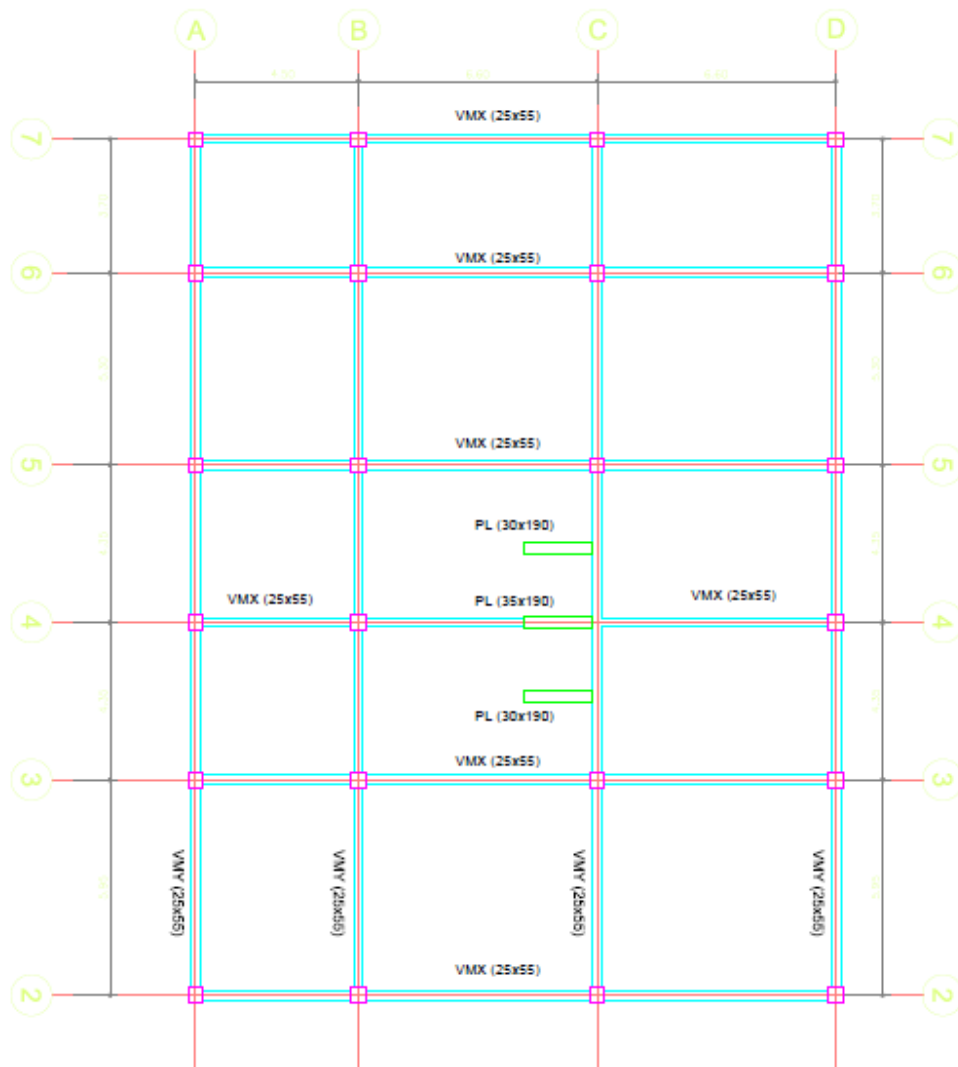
Planta arquitectónica del edificio sin techo verde pisos 3-4.
